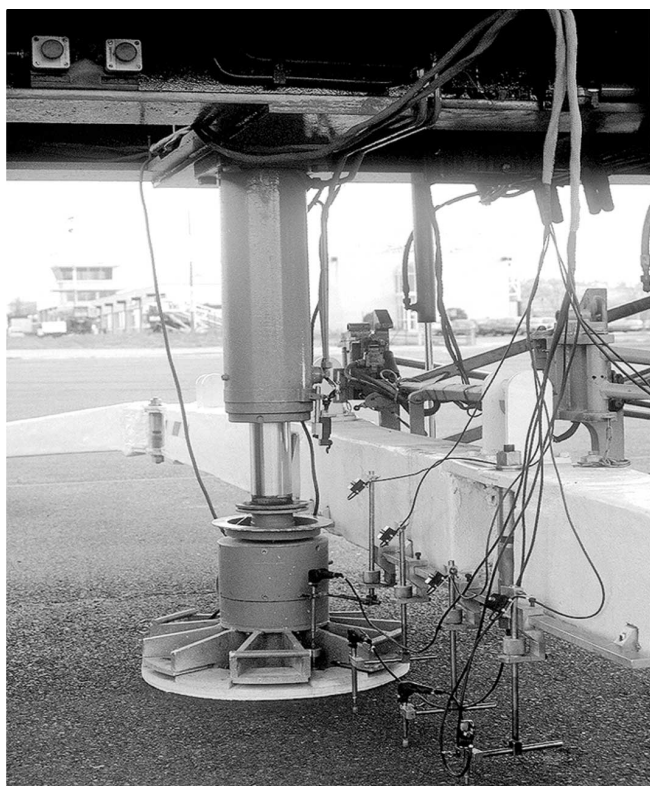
Dispositif d'essai de plaque sur chaussée souple
